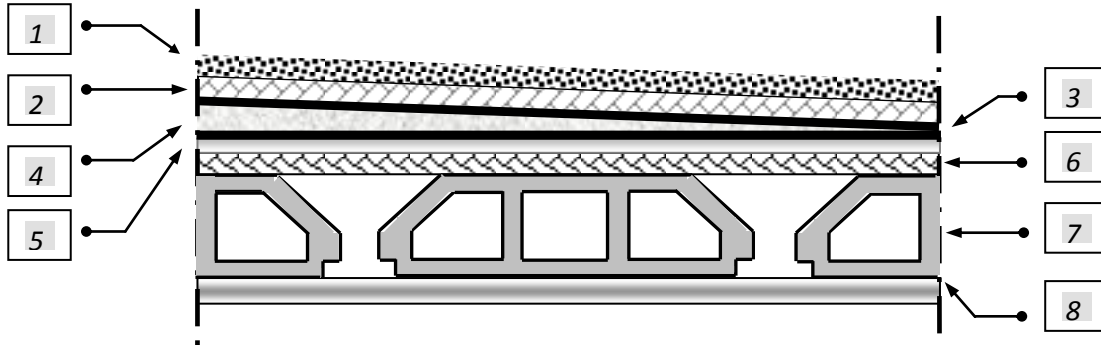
coupe d'un plancher terrasse inaccessible.
